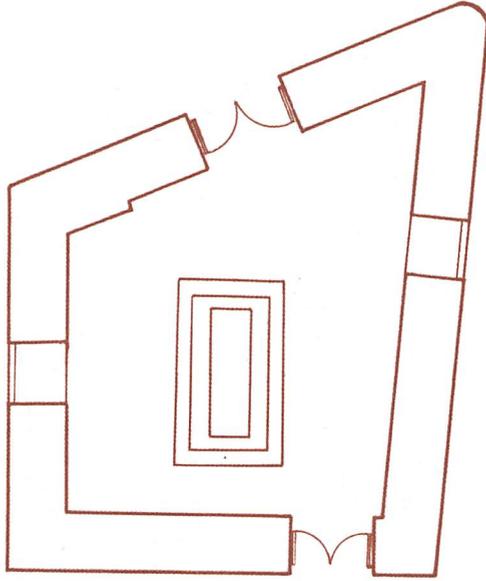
المسقط الأفقى لطوابق مئذنة مسجد التوفيقية
